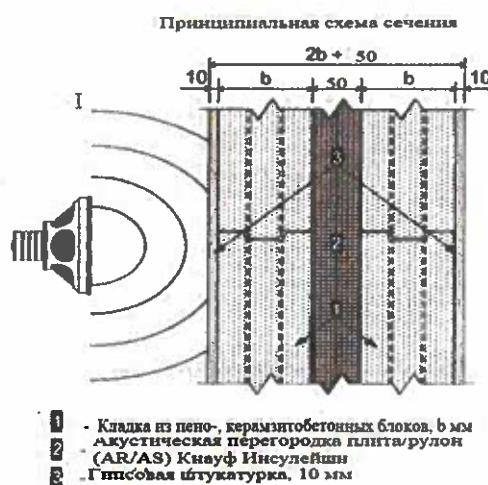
Принципиальная схема сечения бескаркасной стены или перегородки
